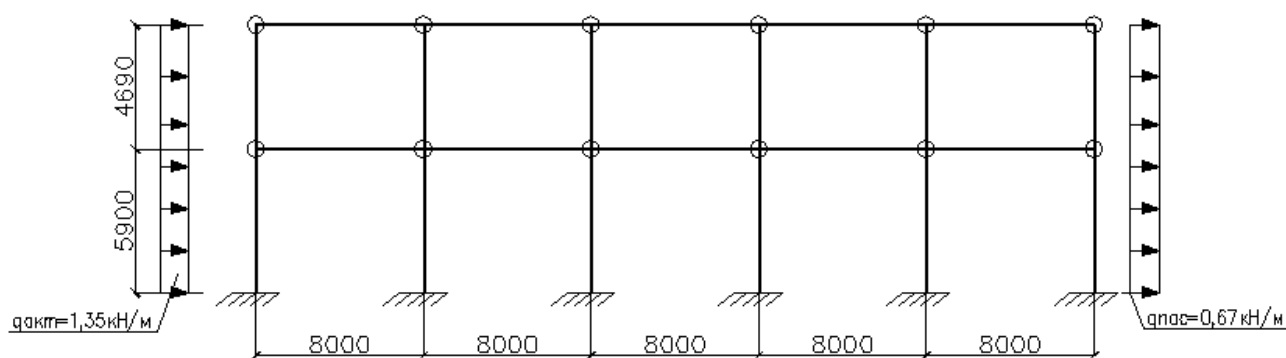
Розрахункова схема рами при визначенні вітрового навантаження
